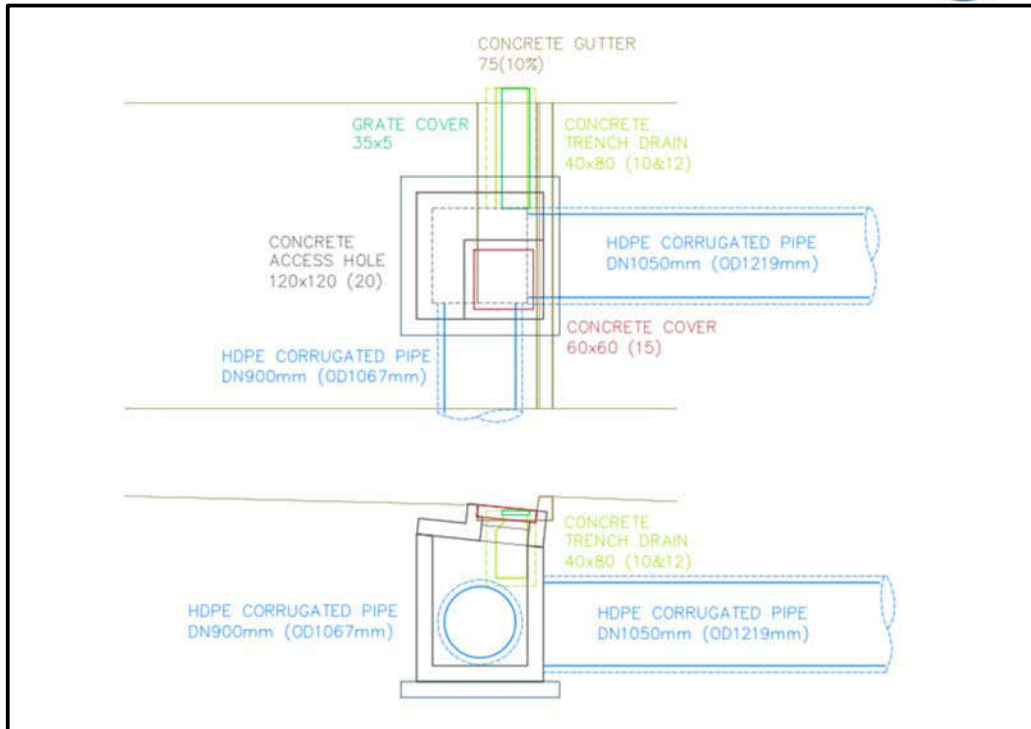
Pamje plani dhe prerjeje e strukturave të kullimit të ujërave të shiut, vrima hyrëse prej betoni
